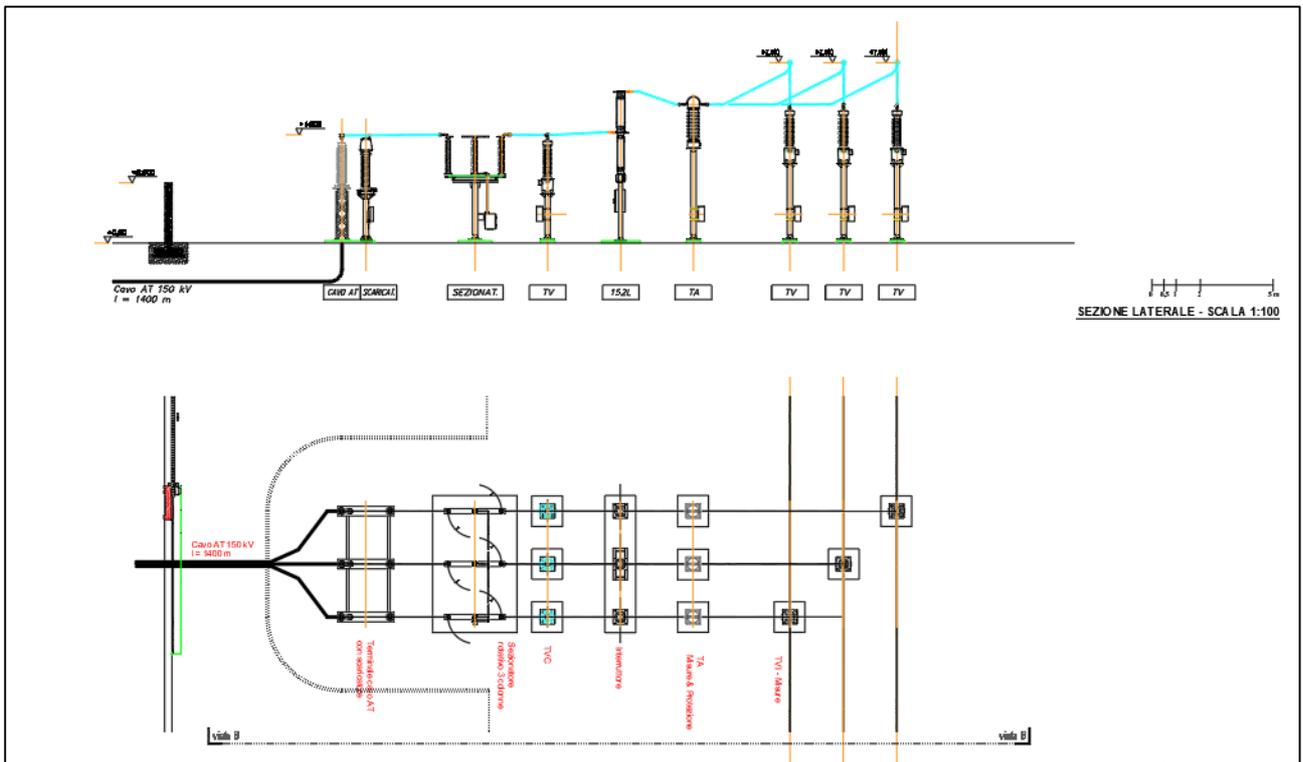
vista laterale e vista in pianta Stallo Partenza Linea 150 kV da condividere
